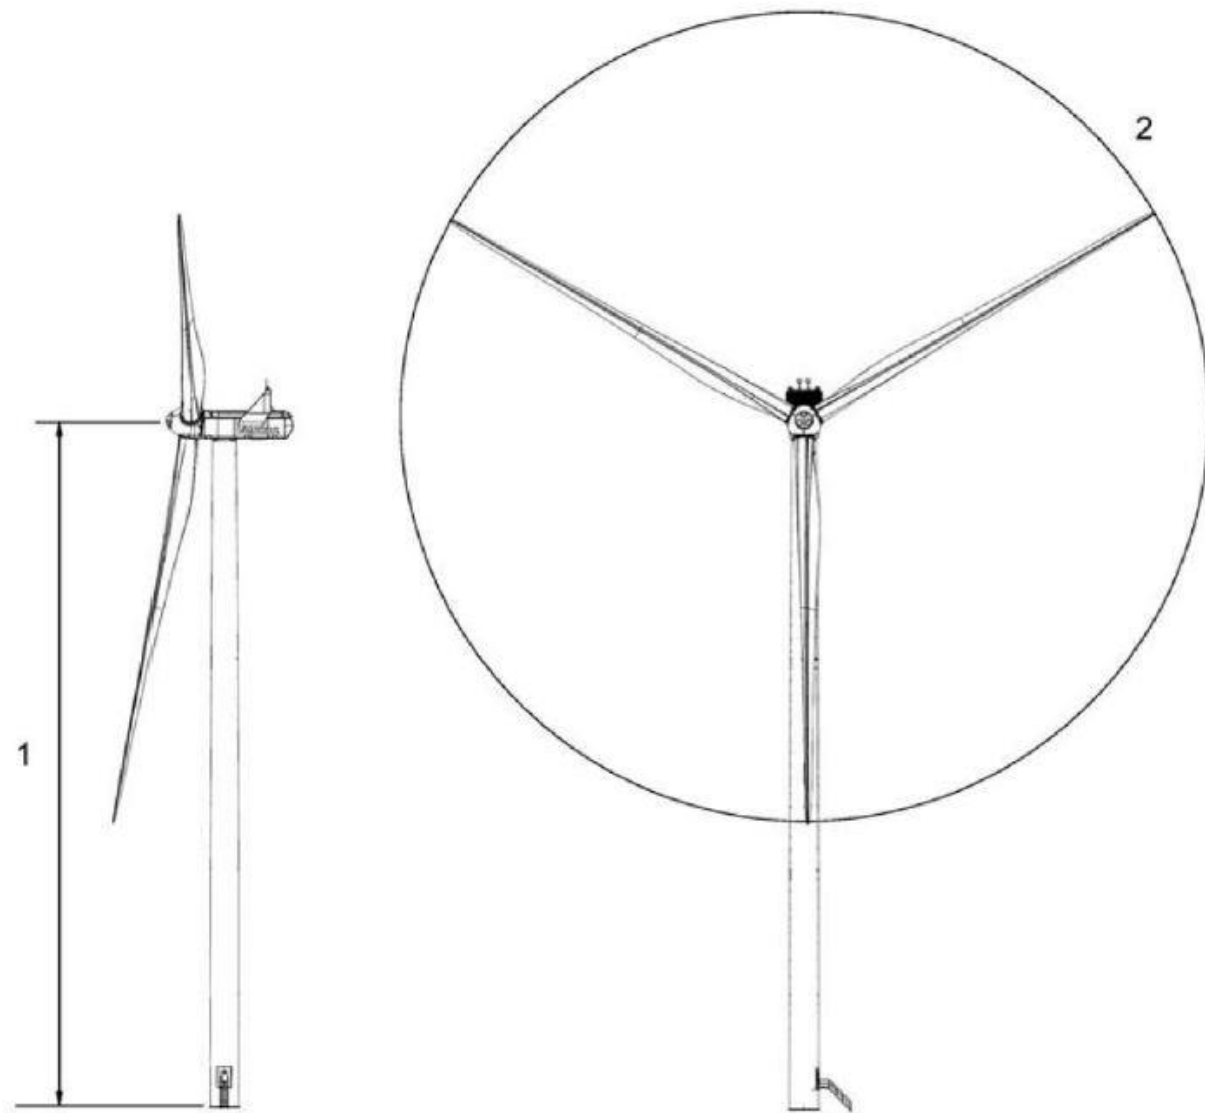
Plan de façade d'une éolienne (1 correspondant à la hauteur du moyeu et 2 correspondant au diamètre du rotor) (source : WPD)
